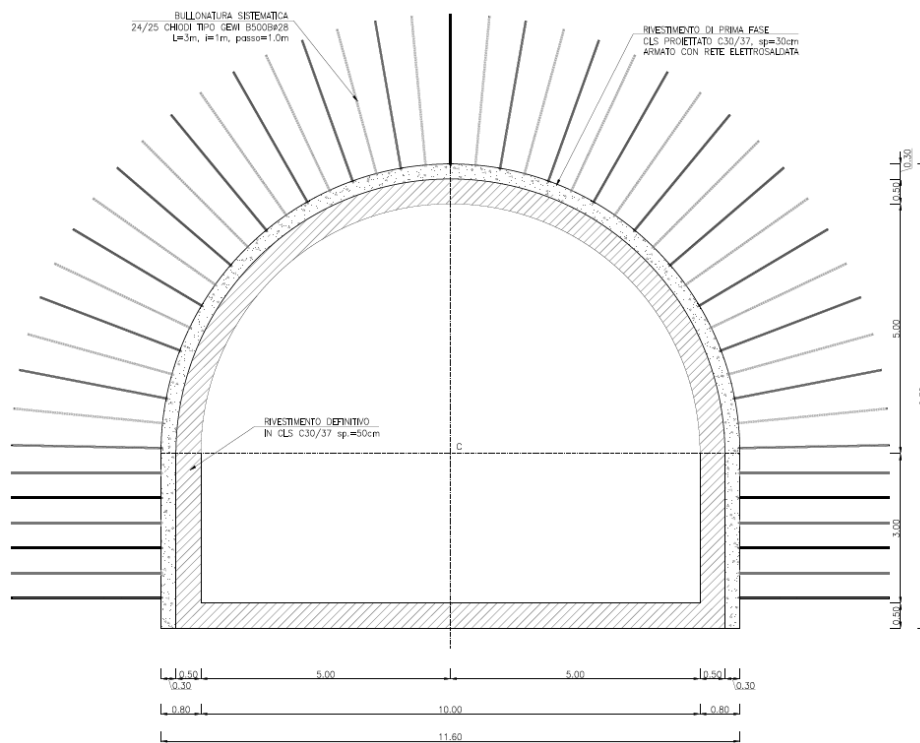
Sezione tipo D1: geometria del cavo e interventi di sostegno
